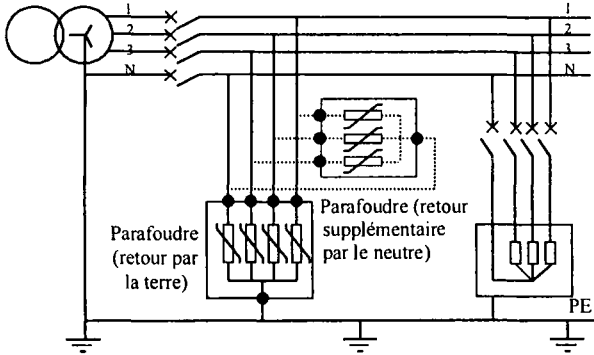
La protection des installations triphasées en régime TN-S par parafoudres
